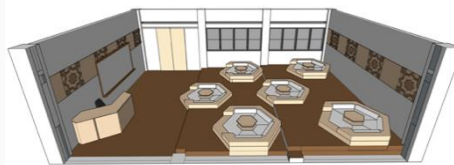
Penyelesaian Elemen Ruang Asrama Tipe A
